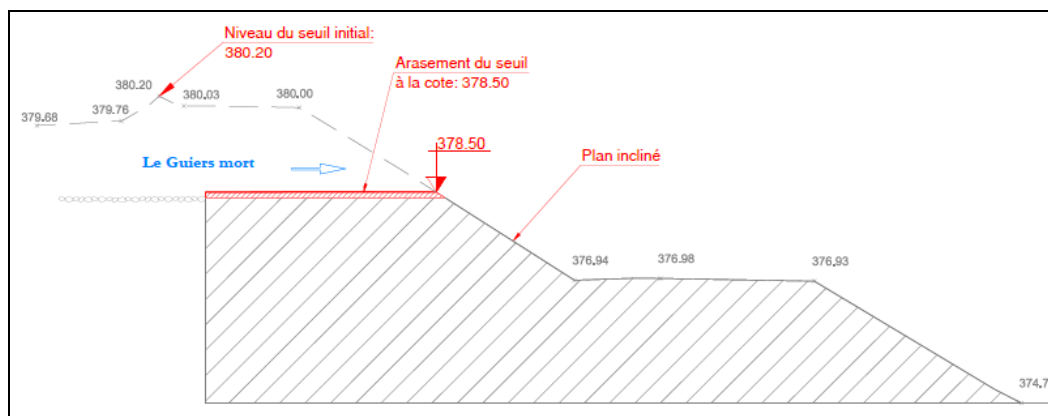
Coupe longitudinale – profil en long - de l'arasement du seuil
